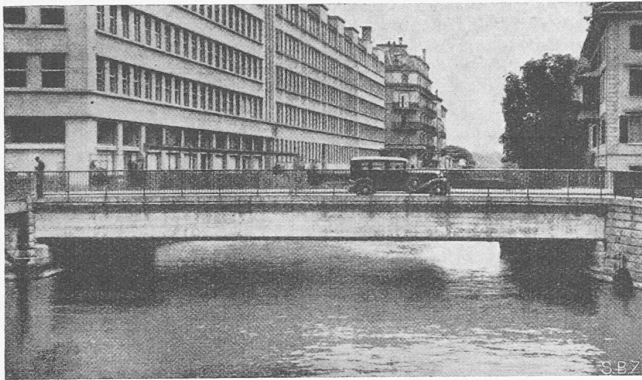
Plattenbalkenbrücke von 21,5 m Stützweite
